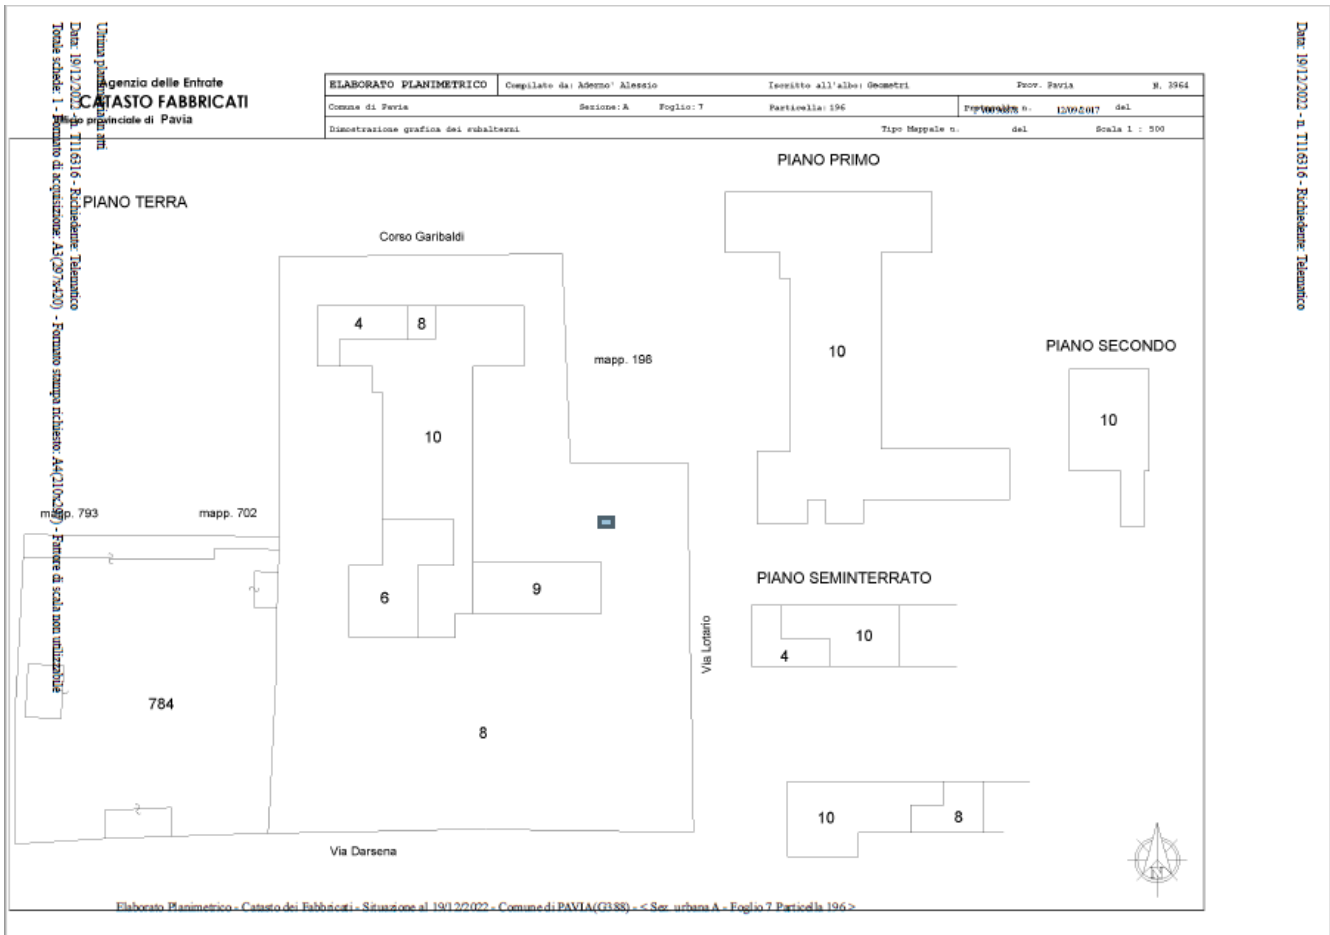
Planimetria Catasto Fabbricati piani: seminterrato – terra – primo - secondo
